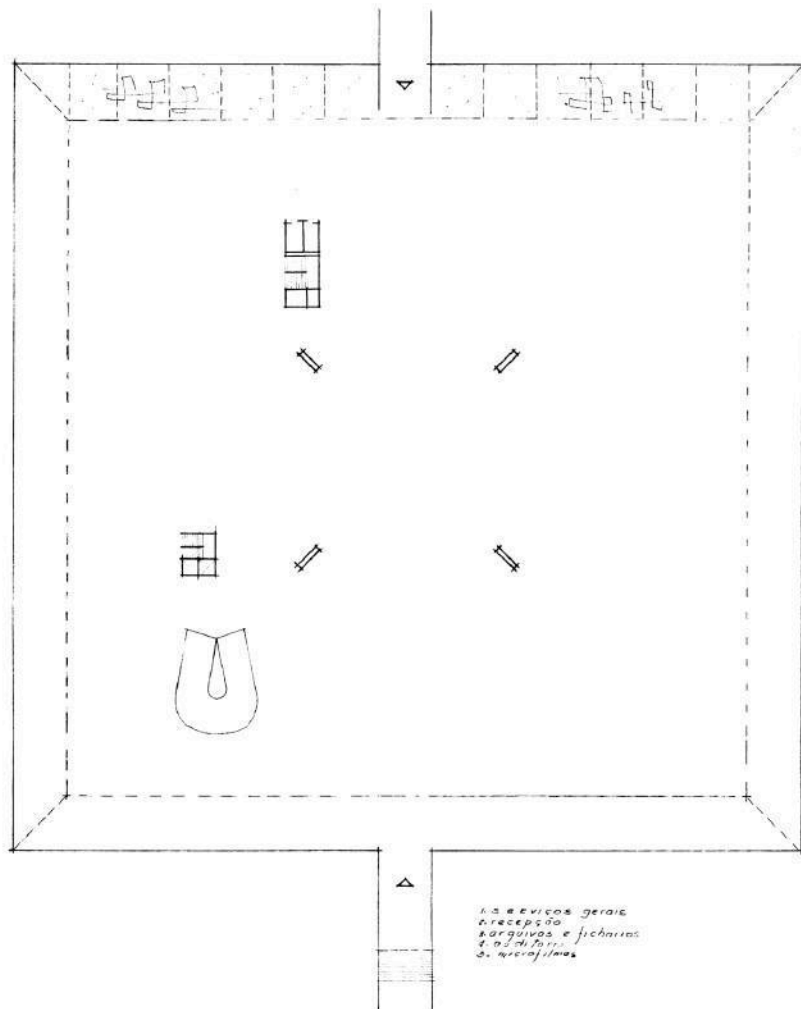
BNB, planta baixa – semienterrado, 1969. Fonte: ArqPDF.
